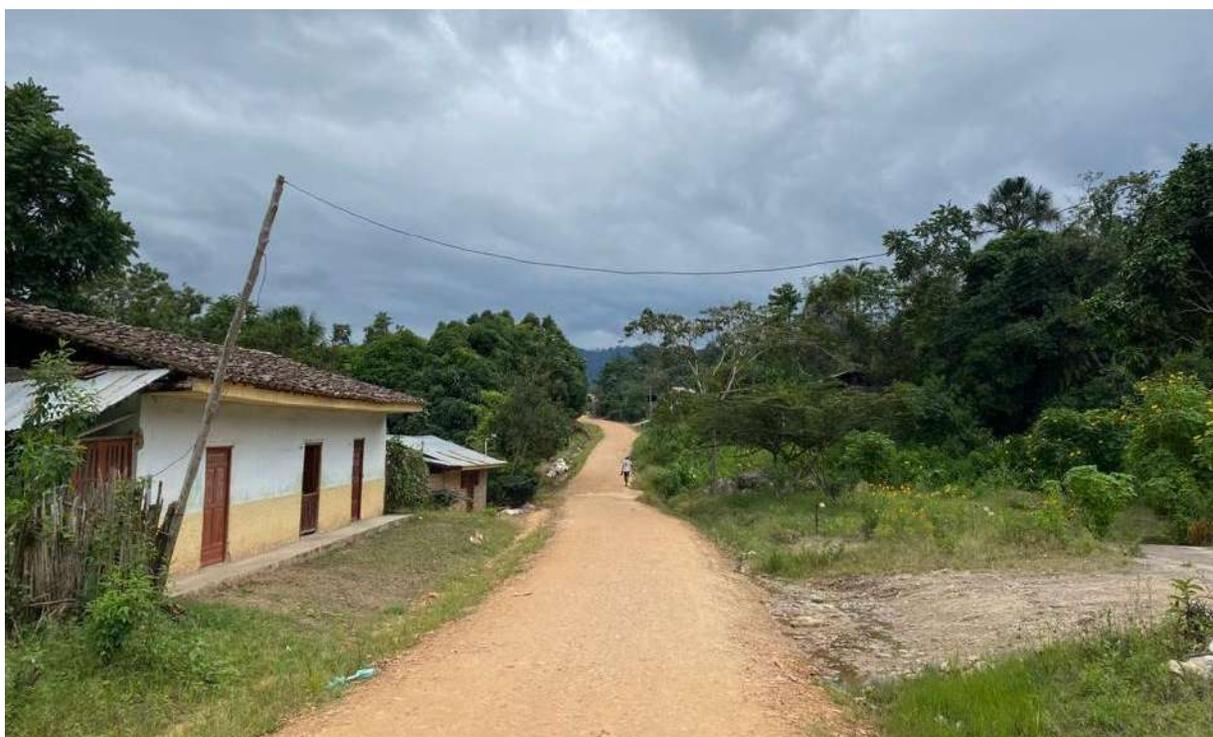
Vista de una vivienda construida con tapial, como material de construcción.
